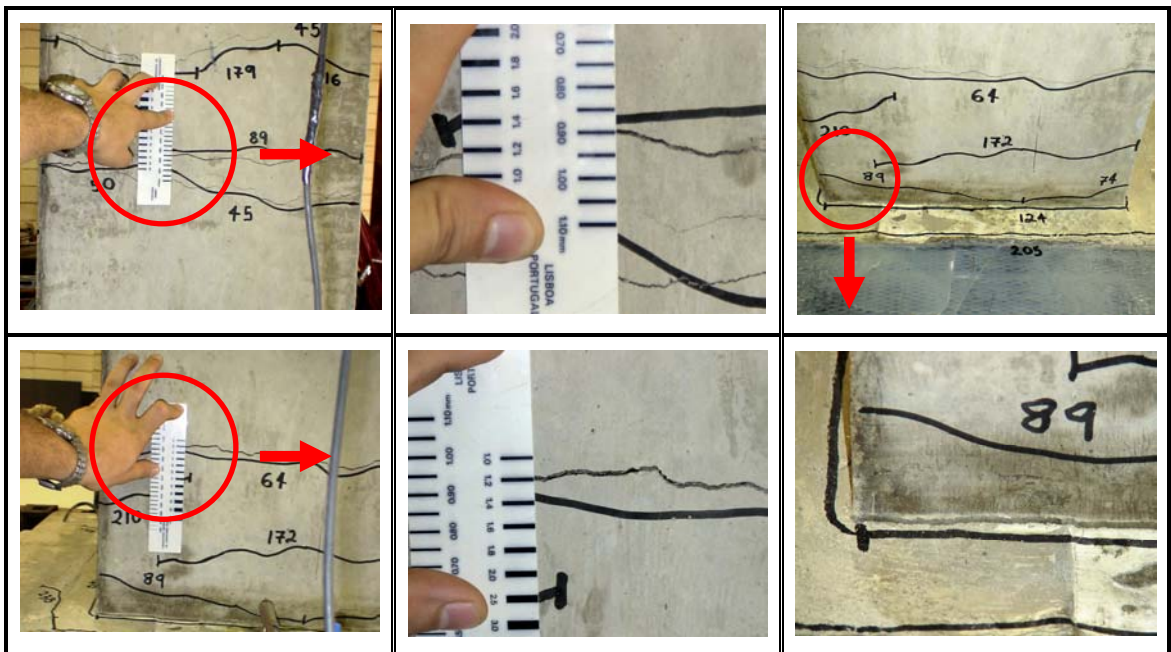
Detalhes das fissuras do modelo PL 80
